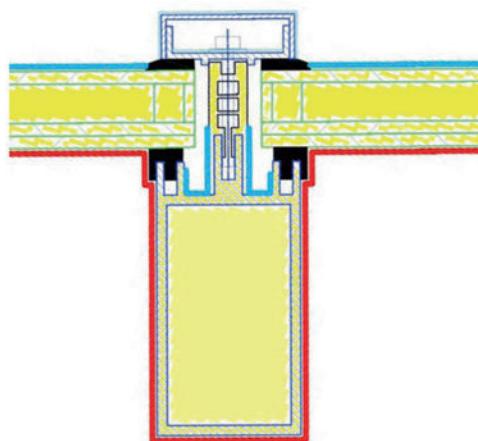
Ebenenmodell an einem typischen Fassaden-Grundprofil mit den drei Funktionsebenen.
